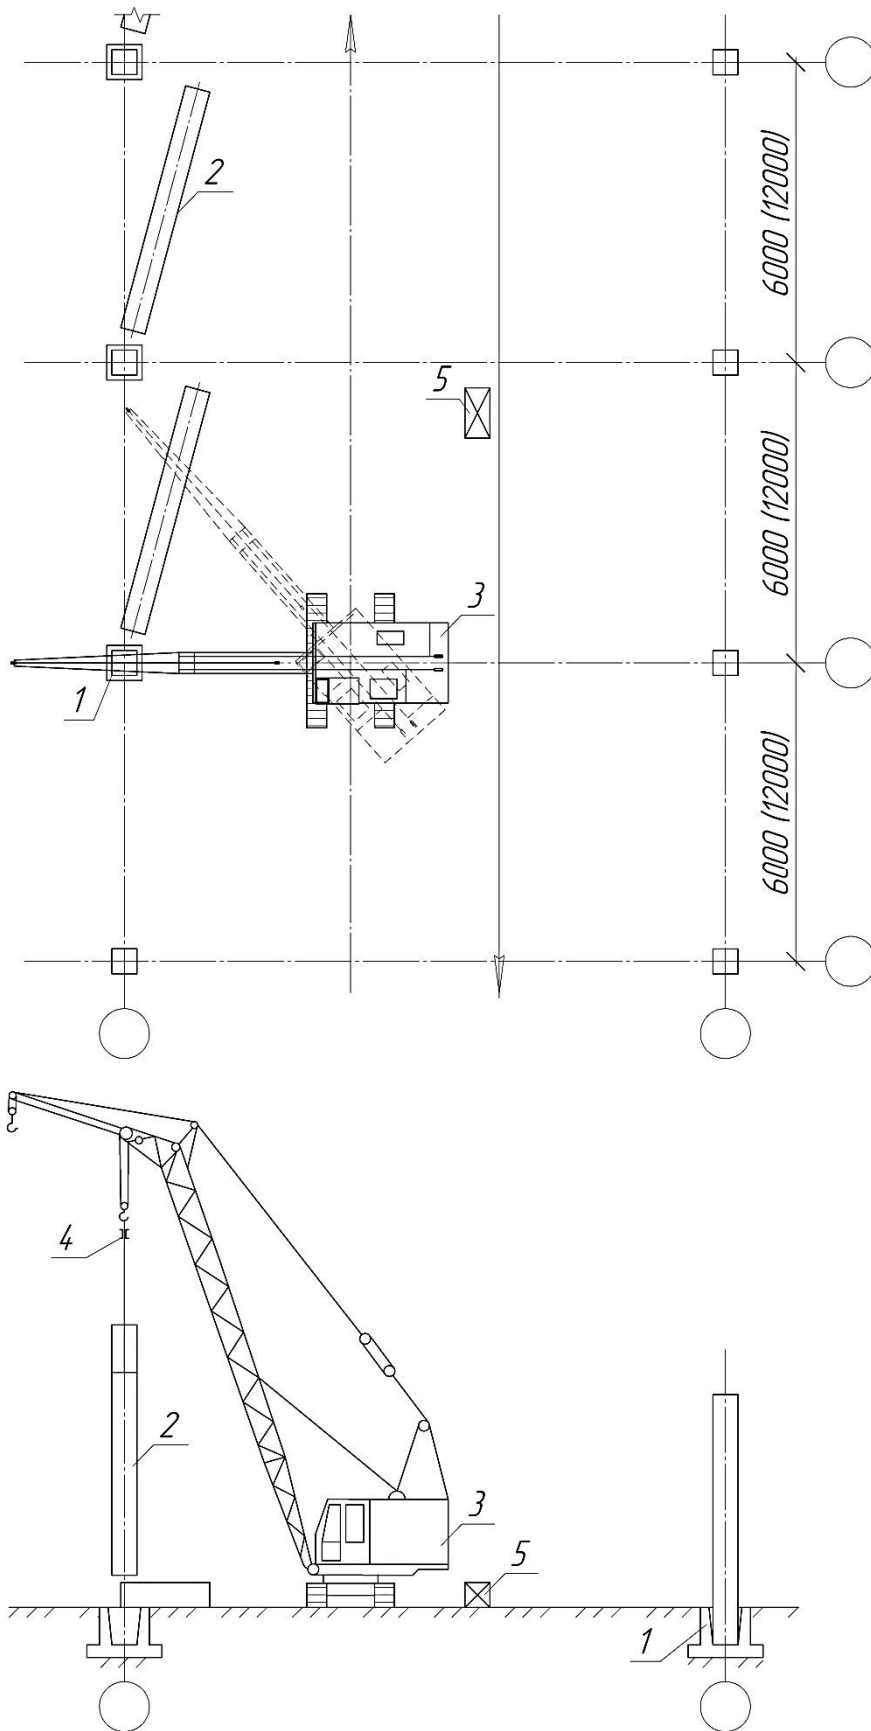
Схема монтажа колонн стреловыми кранами: 1 – стакан фундамента; 2 – колонна; 3 – кран; 4 – траверса; 5 – контейнер с клиновыми вкладышами
